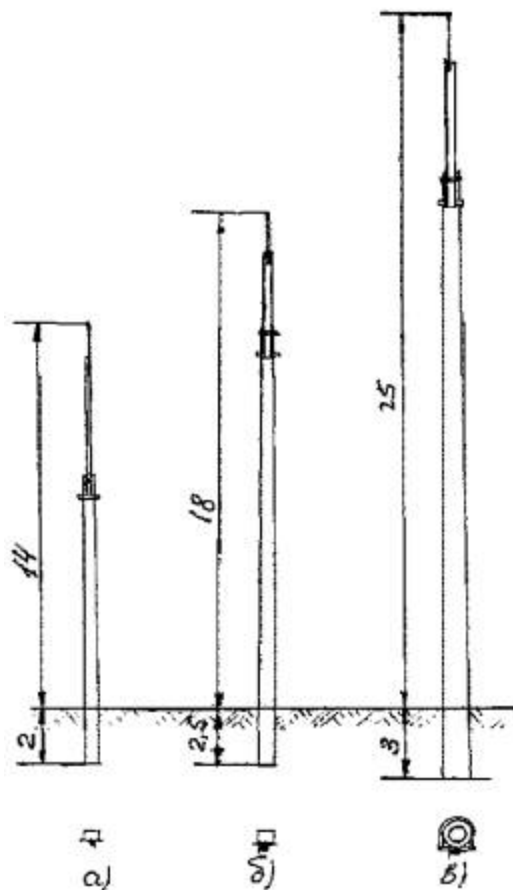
Конструкции стержневых молниеотводов на железобетонных стойках опор воздушных линий электропередачи:
